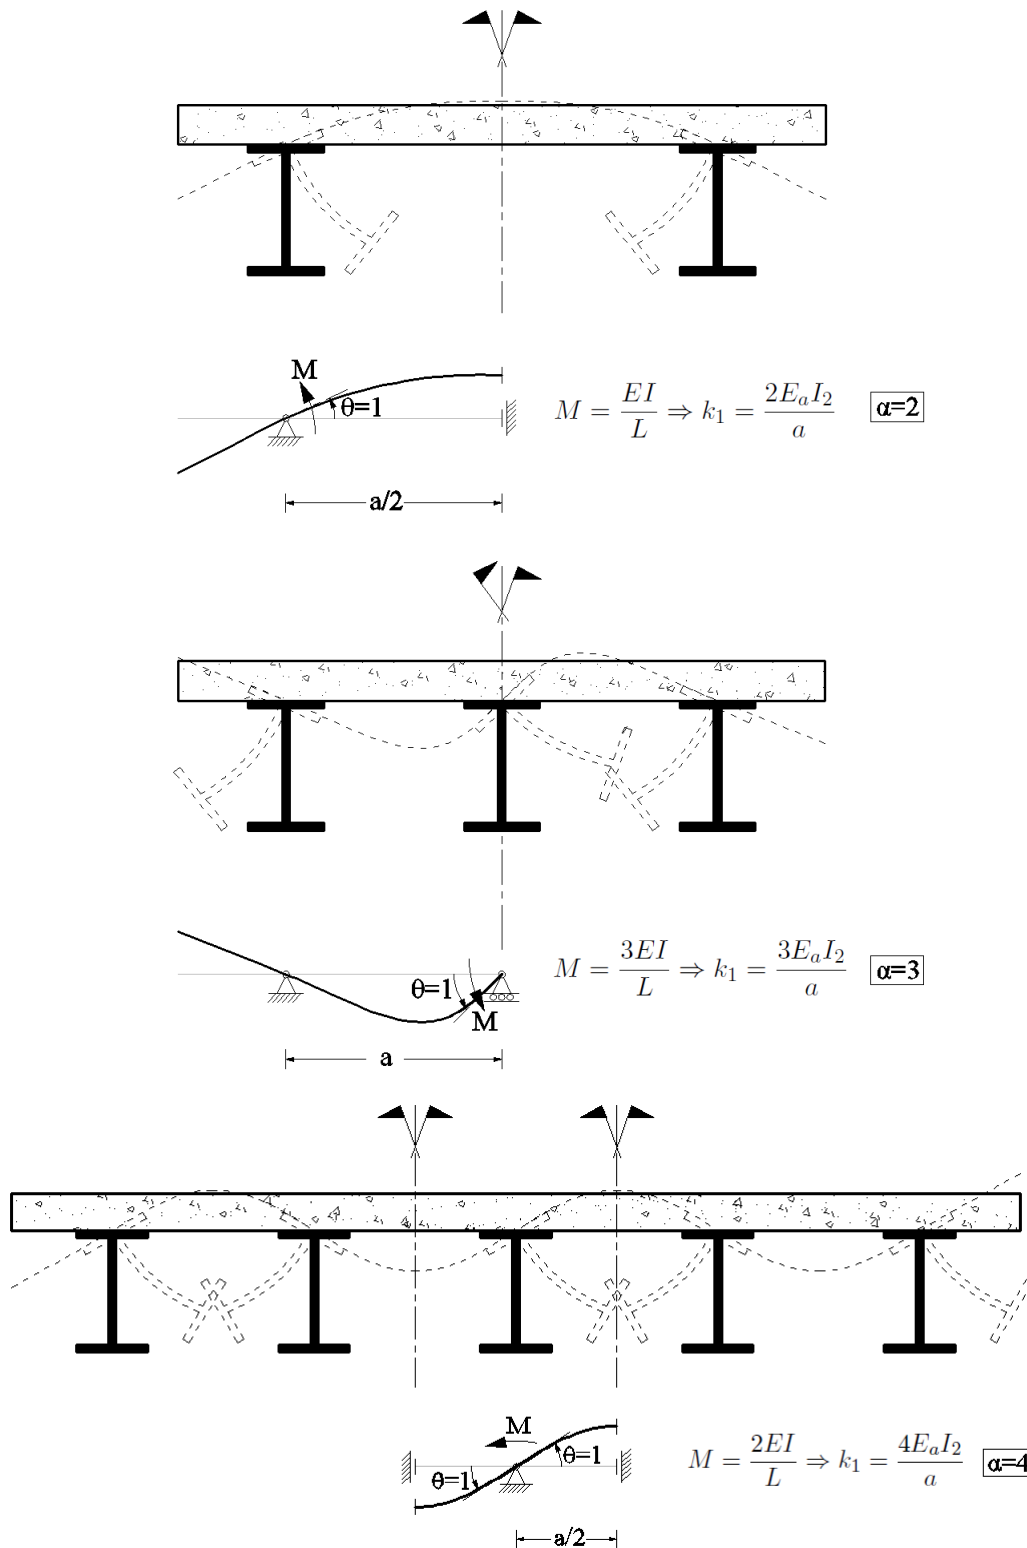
Simplificações para as condições de apoio da laje e modelos de cálculo da rigidez da laje, k_1
